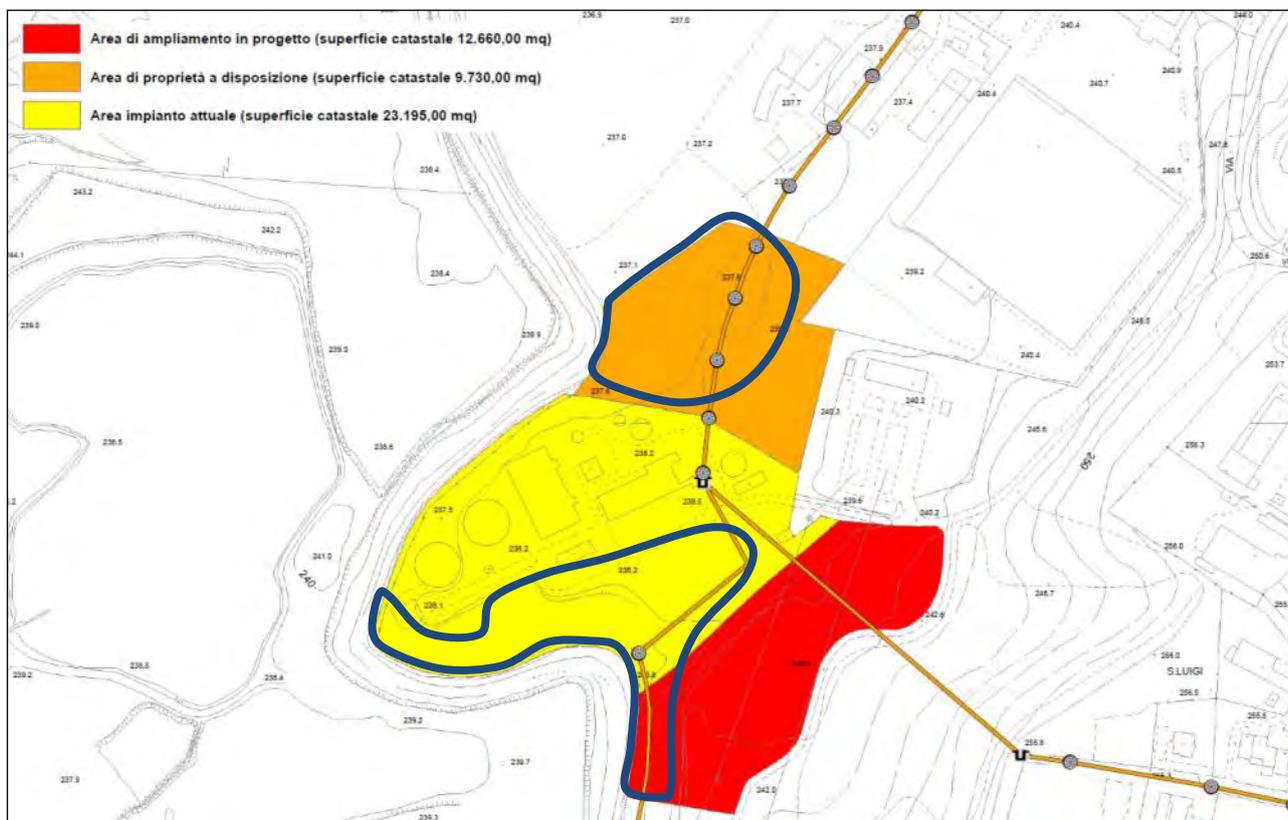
Stralcio catastale delle aree oggetto dell'intervento
